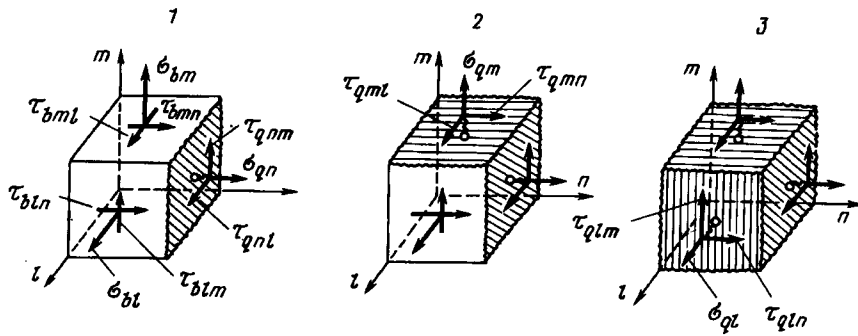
Компоненты напряжений бетона на площадках, нормальных к площадкам трещин (при схемах трещин 1–3)
